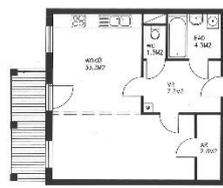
1-2-Zi Wohnung 49 m², Bauteil Arch. Peretti
